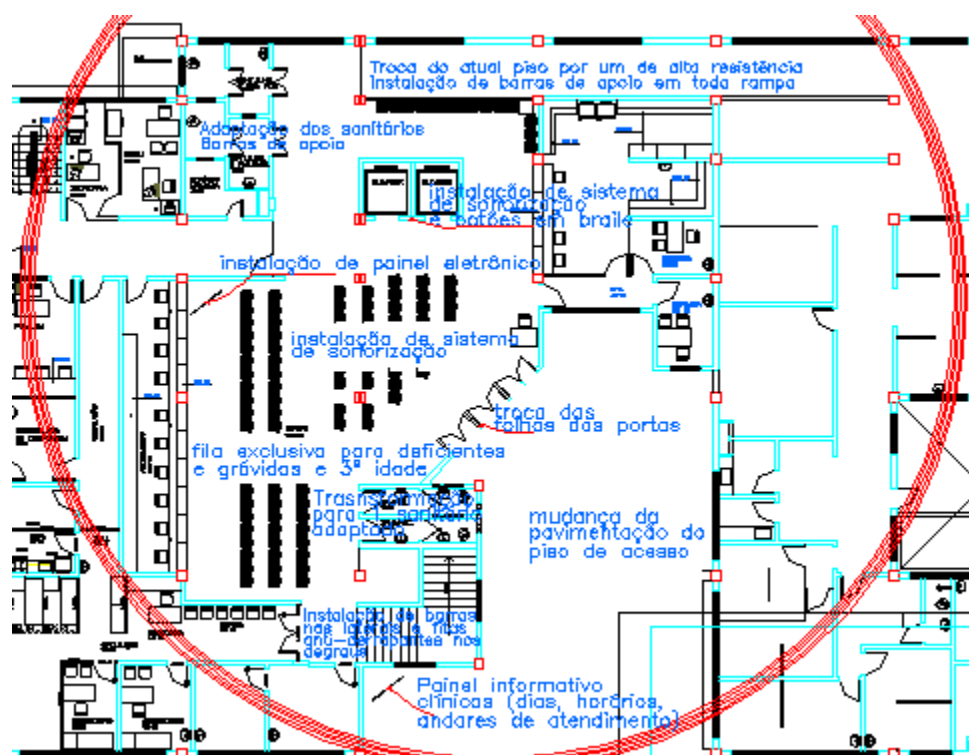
Planta baixa do pavimento térreo do atendimento ambulatorial, propostas. Fonte: Cedido pelo HUPES. Alterações da autora.
